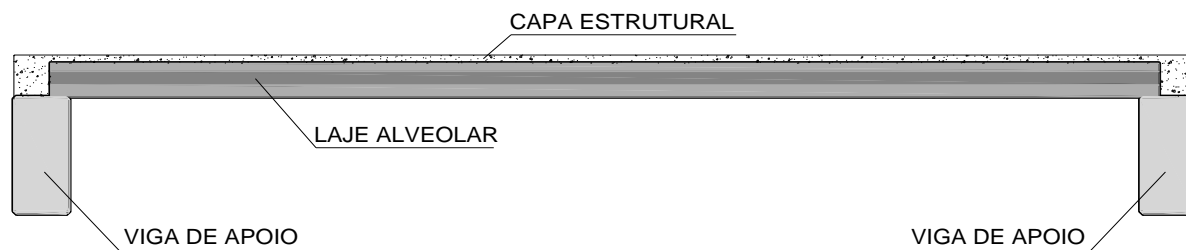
20 – Vista lateral de um elemento alveolar no pavimento.
